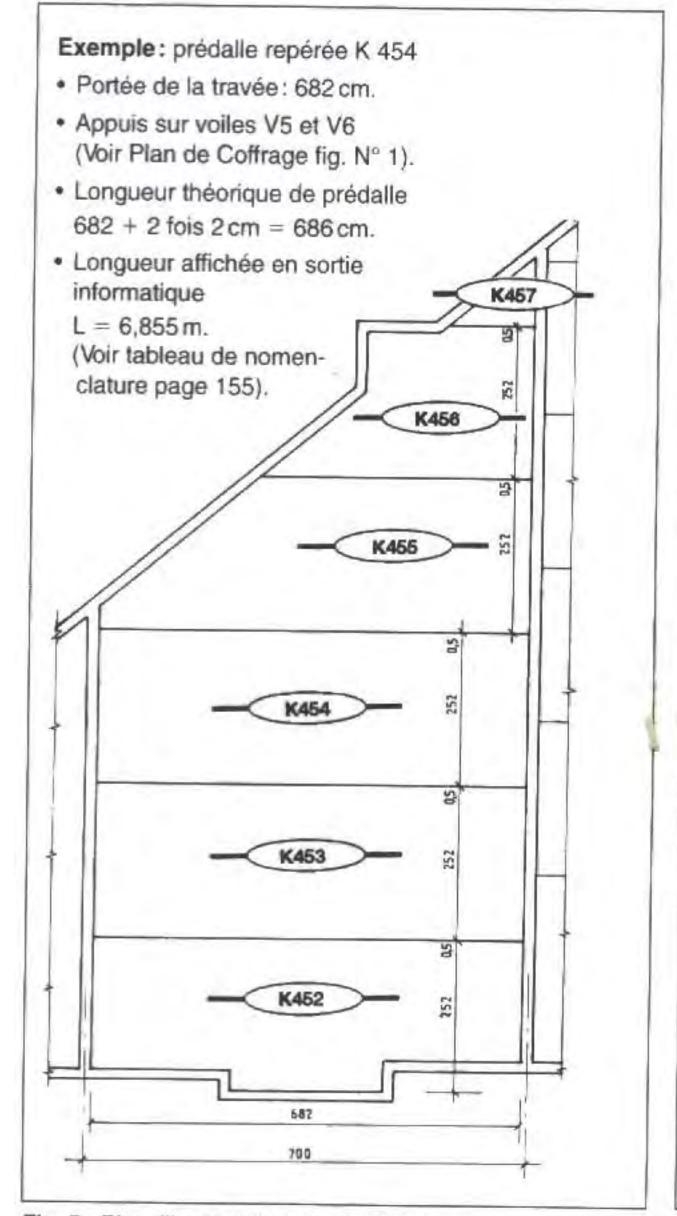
Plan d'implantation des prédalles extrait du plancher de la page 148
